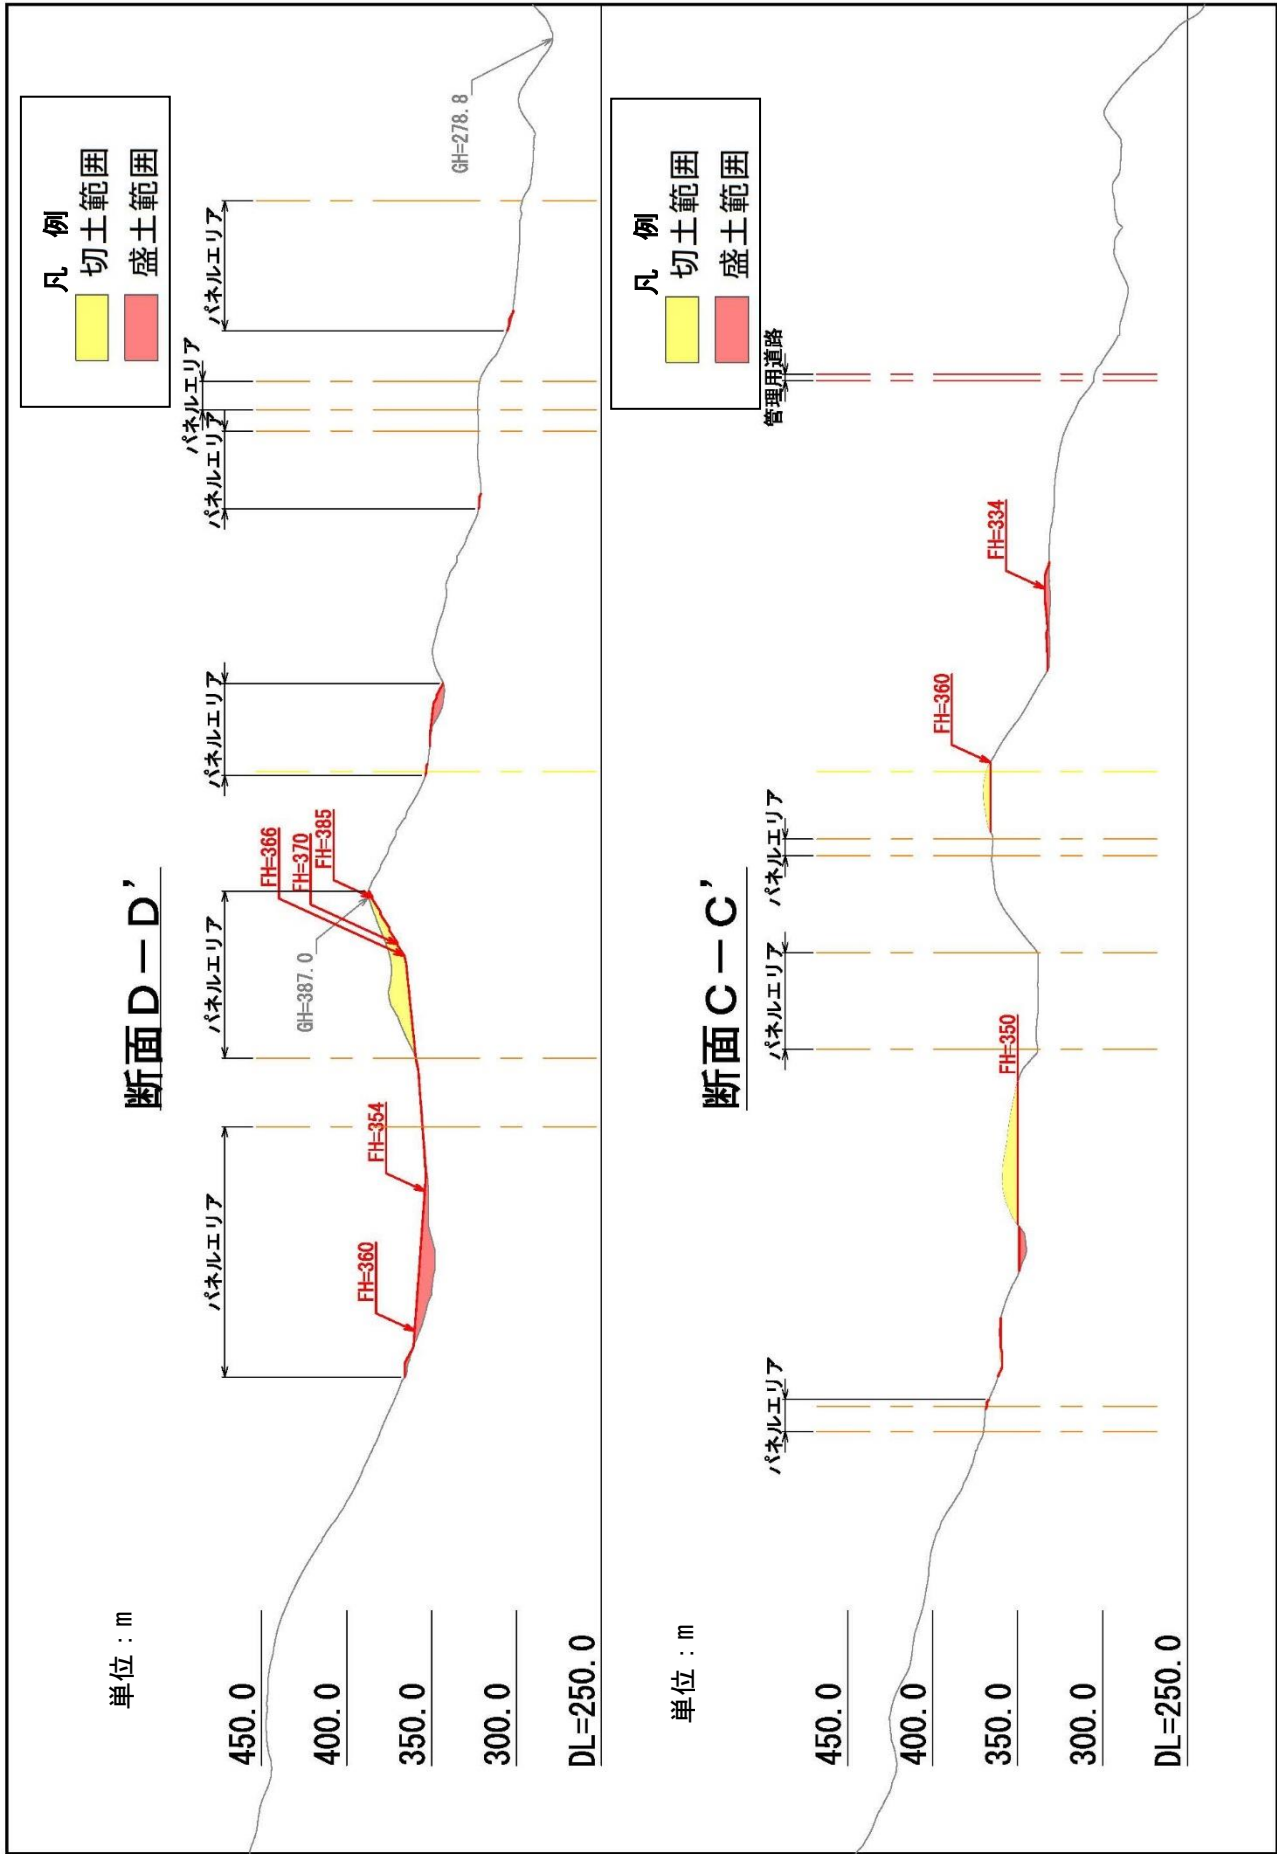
切土盛土計画断面図 (C-C' 断面、D-D' 断面)
